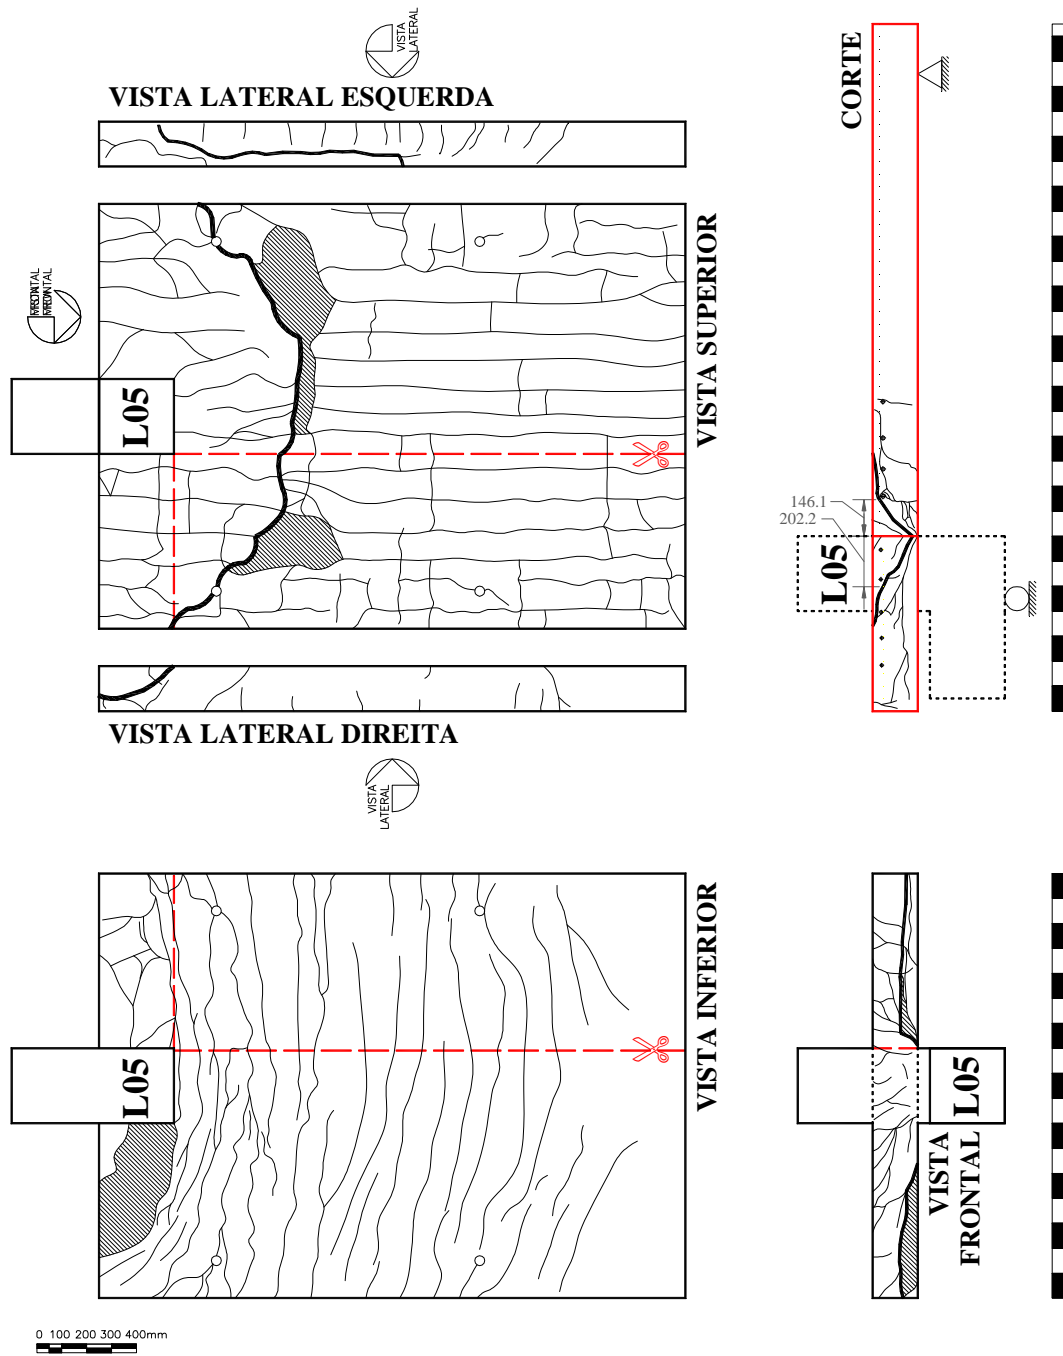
Padrão de fissuração da laje L05
